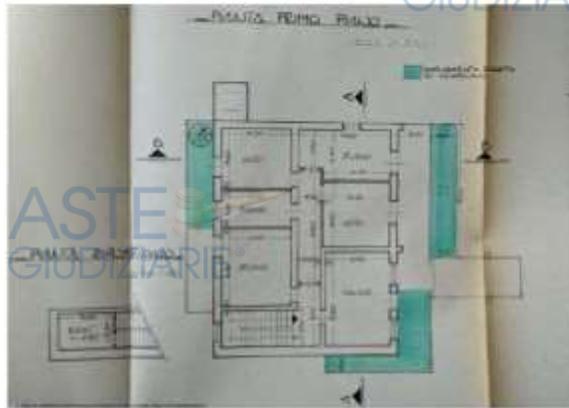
Pianta del primo piano, con ampliamenti evidenziati in turchese
